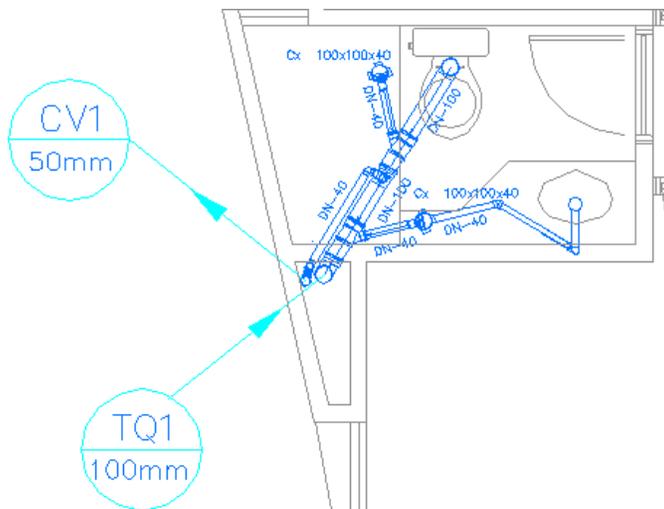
Exemplo de Planta Baixa ou Detalhe de Esgotos escala 1:20 ou 1:25.
